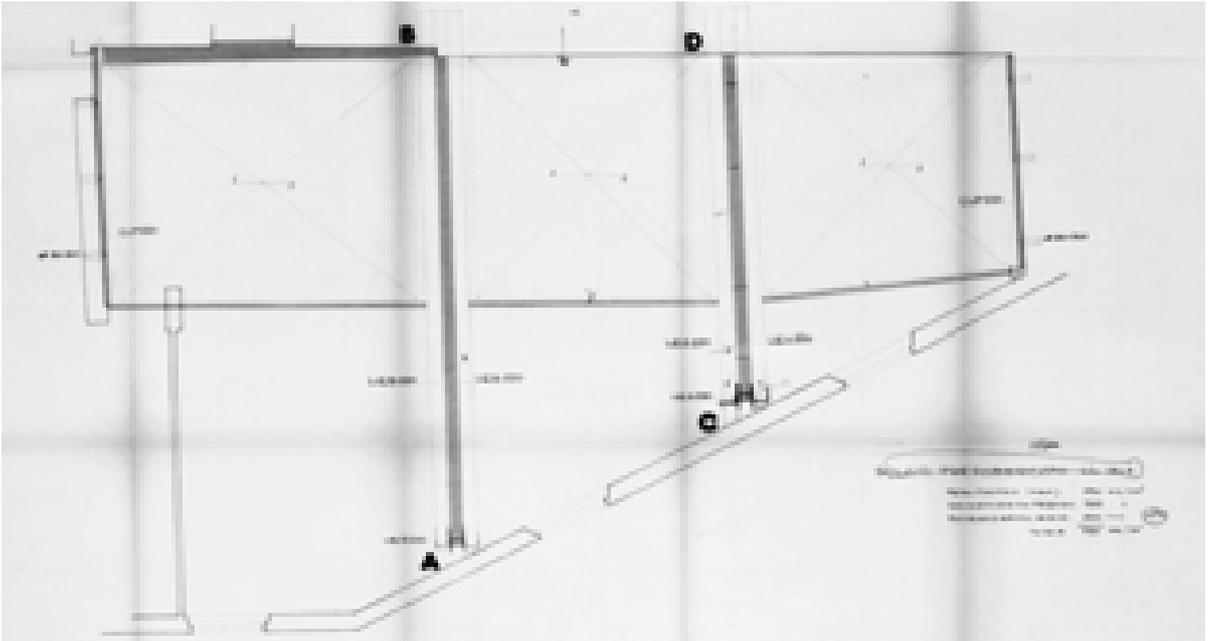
Pianta +2,72 – esecutivo strutture - Carlo Succi – 25/02/1980 (AABS-95.426)
